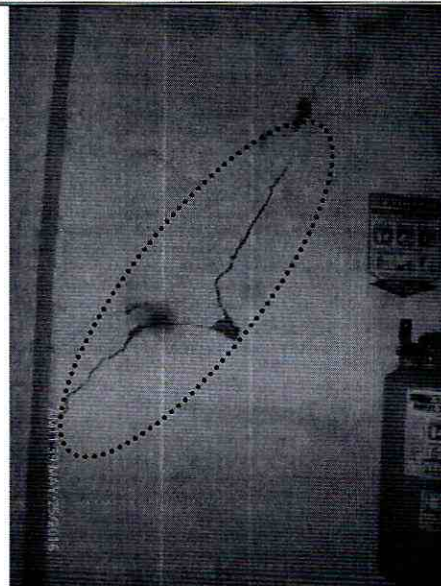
Presencia de grietas y fisuras en los muros de cerramiento de la zona de estacionamiento del Conjunto Residencial La Esperanza I y II P.H. de la Calle 163B No. 45 - 32, en el Sector Catastral Britalia de la Localidad Suba.
